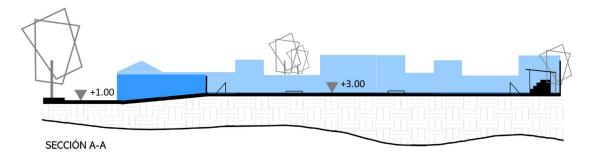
Sección Transversal A-A, Fuente: Elaboración Propia
